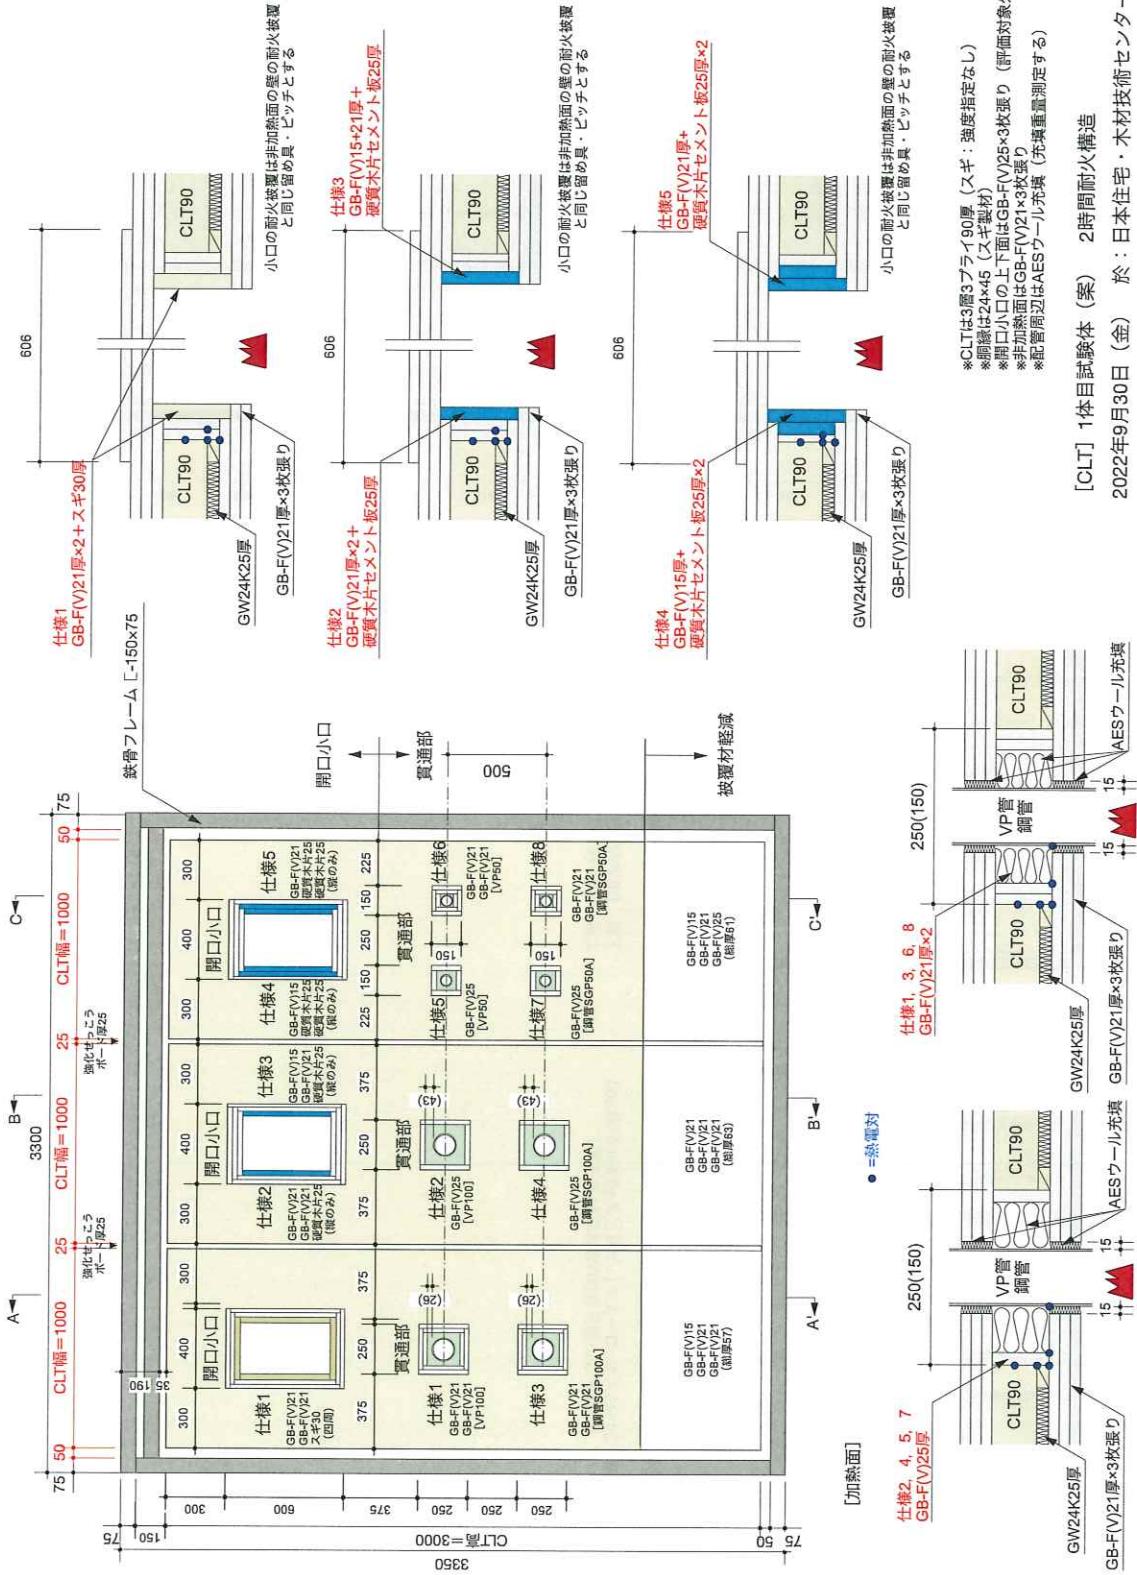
試験体 1 の構造・寸法（単位：mm）
